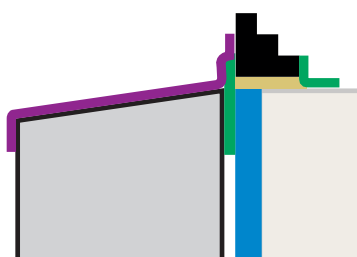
DETAIL CONSTRUCTIF COLLAGE DE FENETRE
